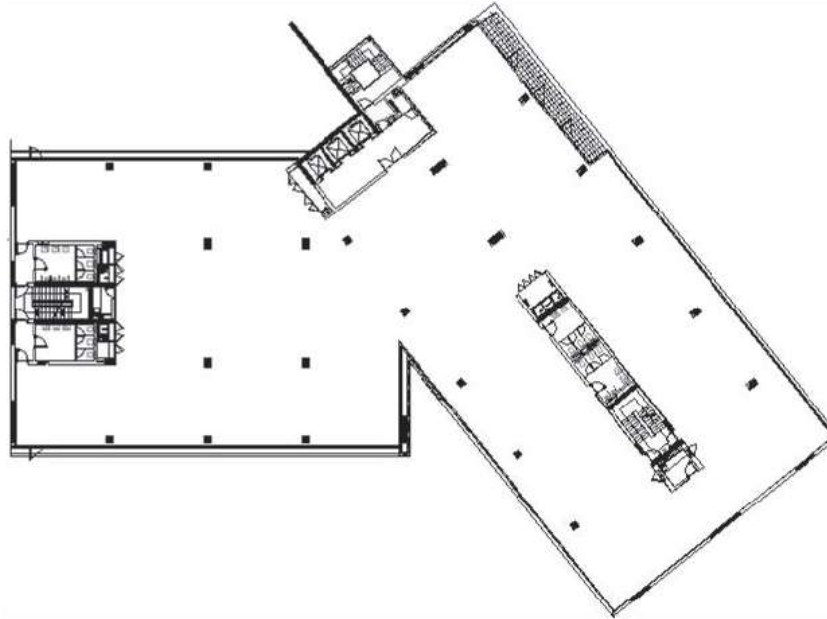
Planta Tipo do Edifício C do Complexo Alfrapark (Fonte: Alfrapark.com)
